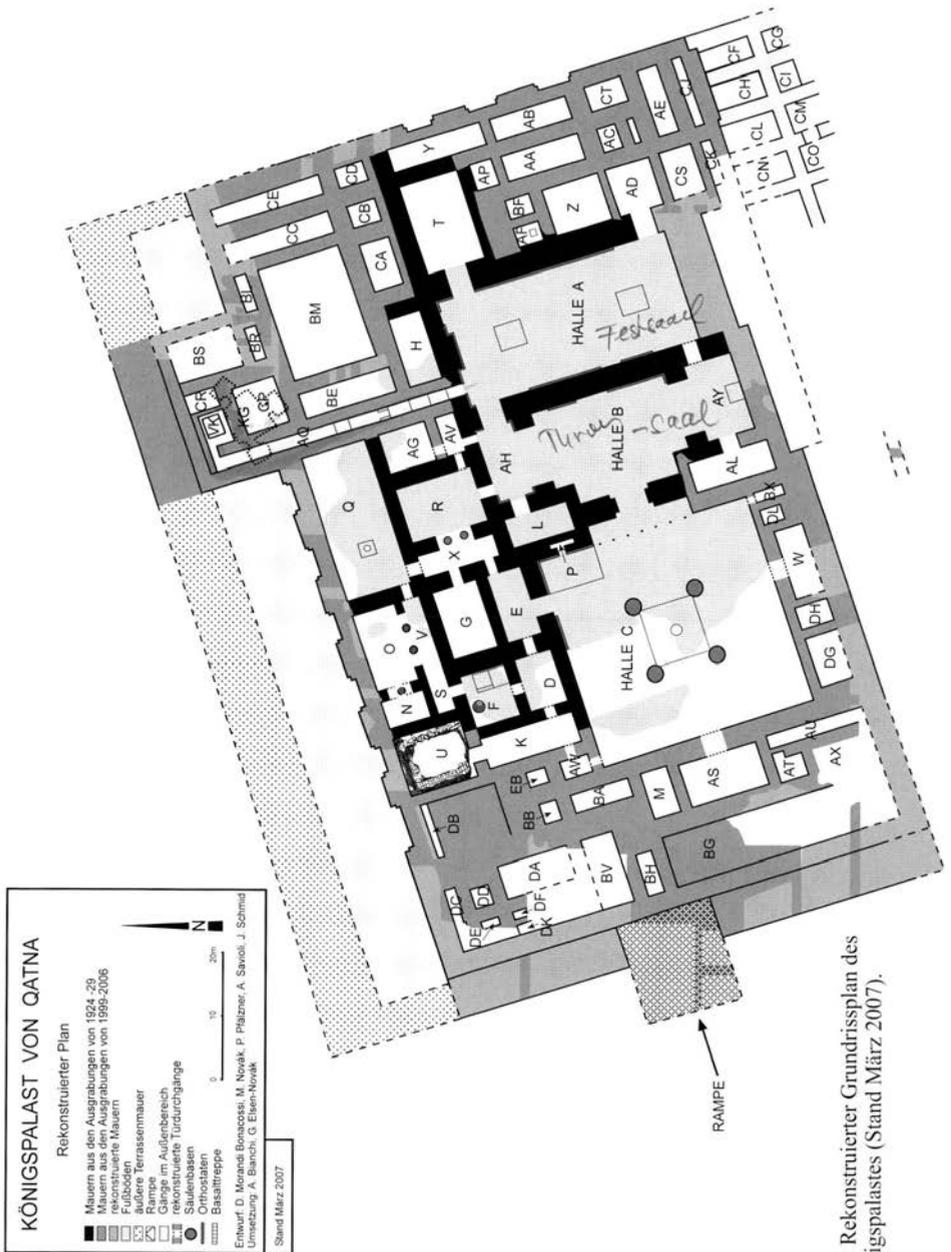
Rekonstruierter Grundrissplan des Königspalastes (Stand März 2007).
